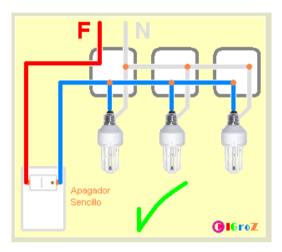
CONEXIÓN PARALELO CON SWITCH
